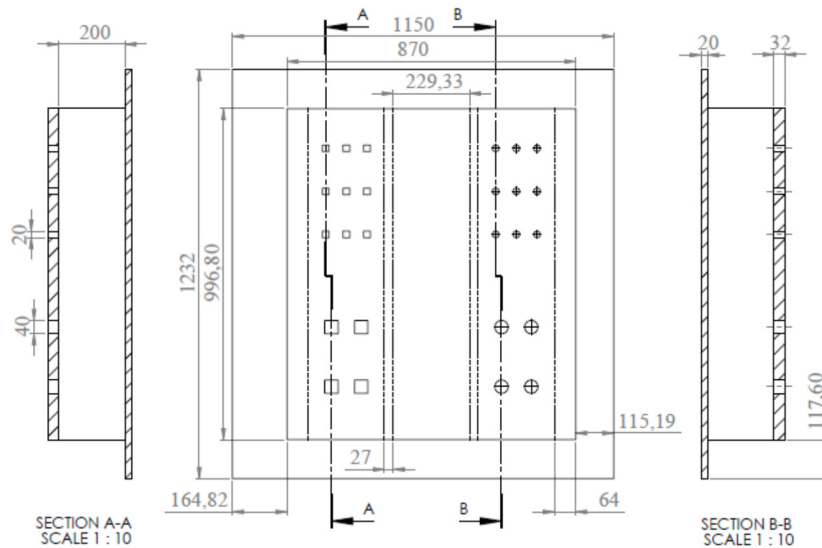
Desenho do modelo de pavimento/cobertura com perfurações.
